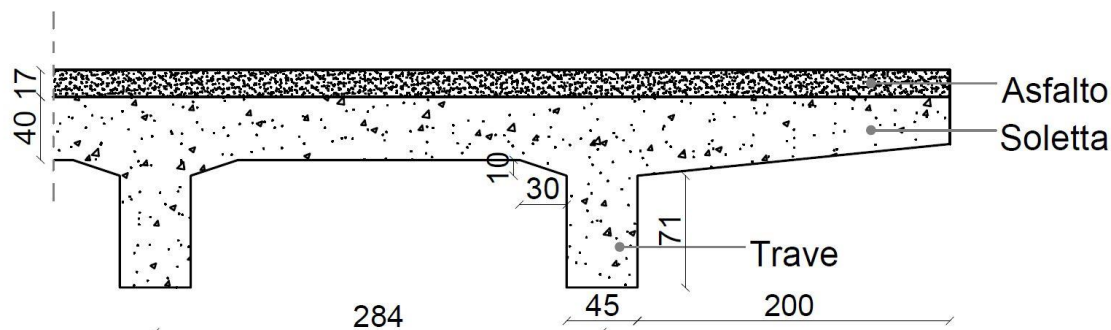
Sezione trasversale impalcato, in corrispondenza dello sbalzo
